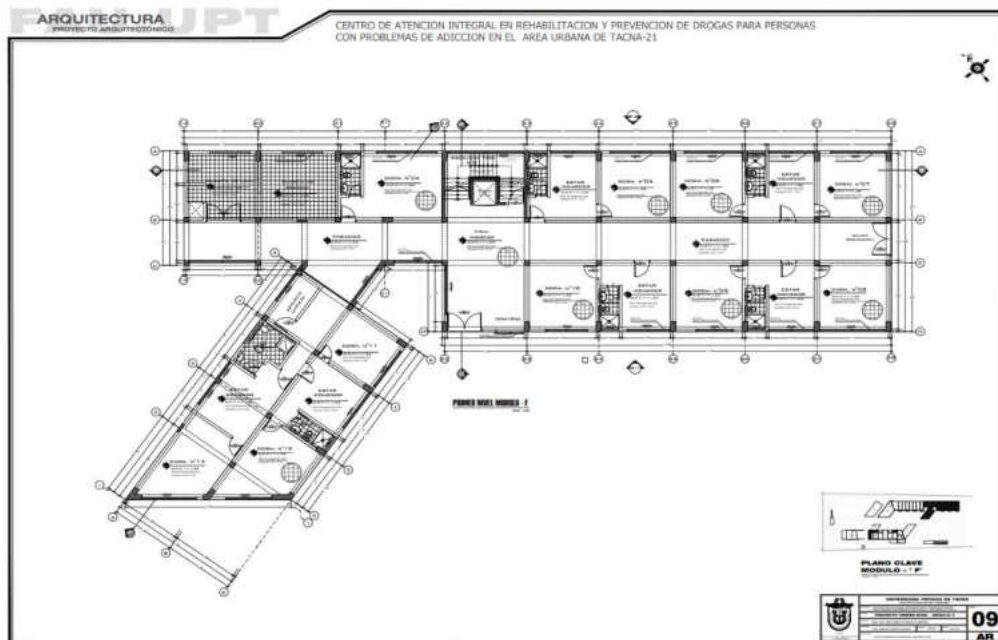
Plano primer nivel bloque F, fuente elaboración propia.
